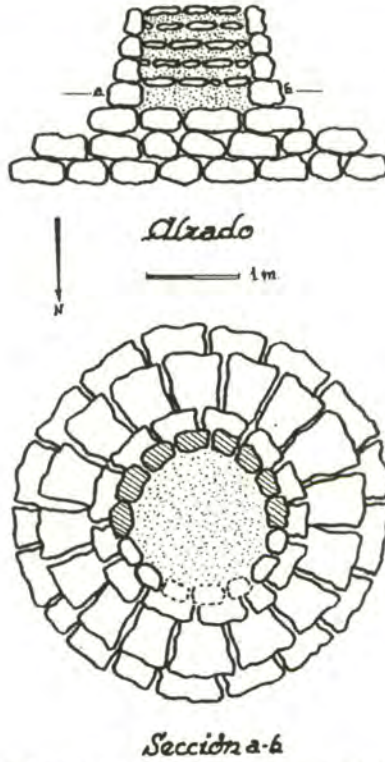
Planta y alzado del ara de sacrificio excavada en el Cabezo del Jabie, El Julan (Isla de El Hierro)
